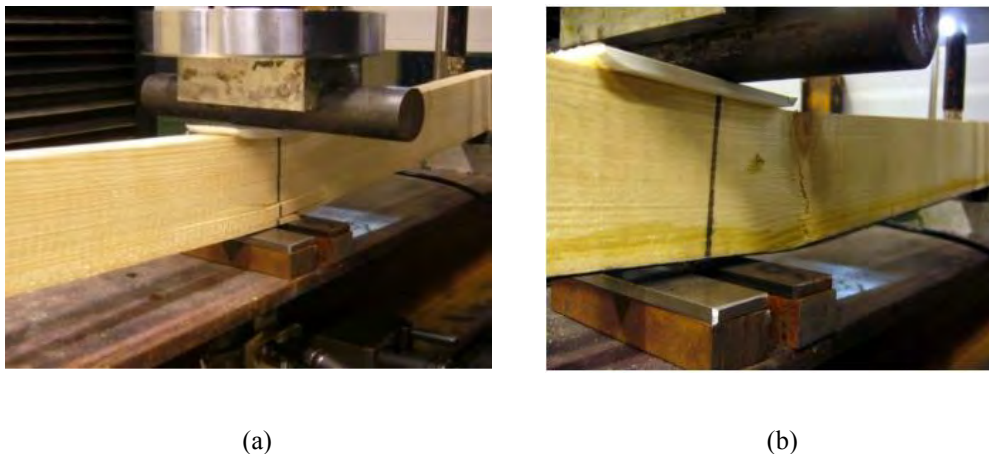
Rupture en traction des poutres en bois (a) poutres non-renforcées (b) poutres renforcées (d'après Nguyen 2010)
